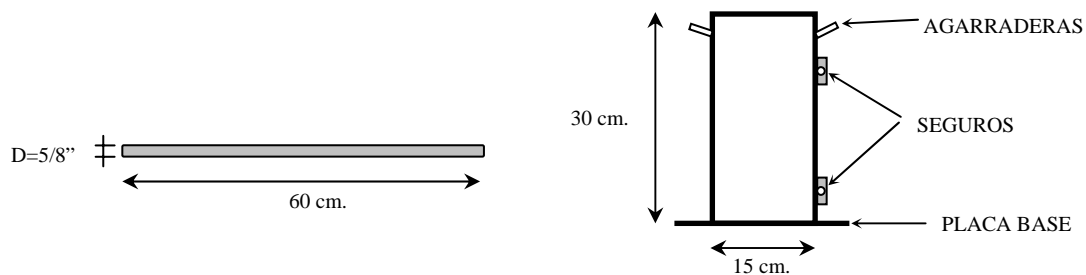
esquema de varilla y cilindro metálico para la extracción de muestras de concreto
